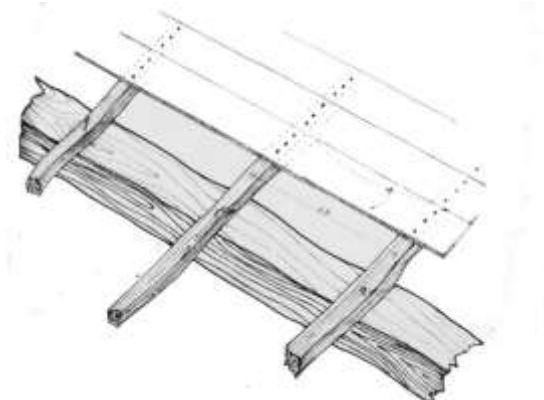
Detalle constructivo entrepiso de madera sobre viga y atirantado.
